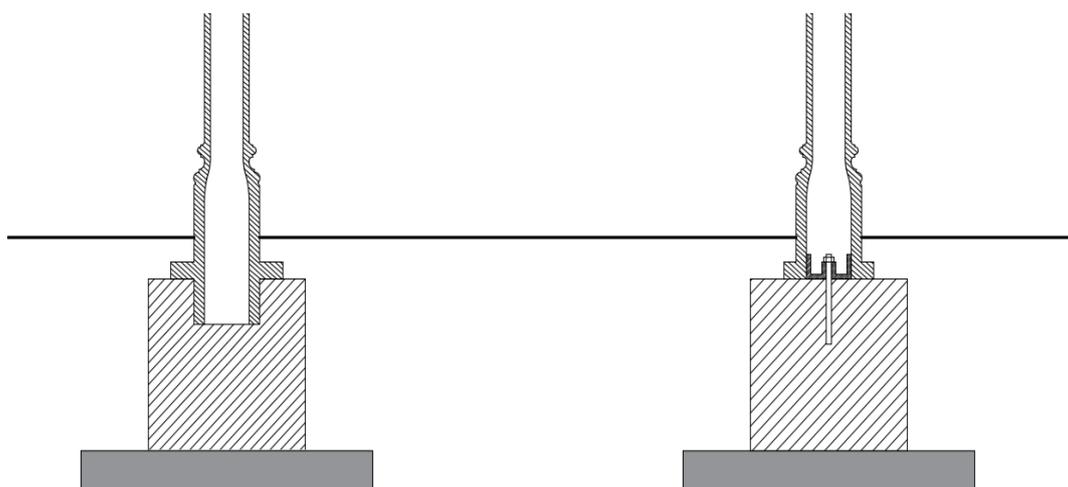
Hipótesis de encuentro zapata-cimentación en la fábrica Fontecha y Cano.
